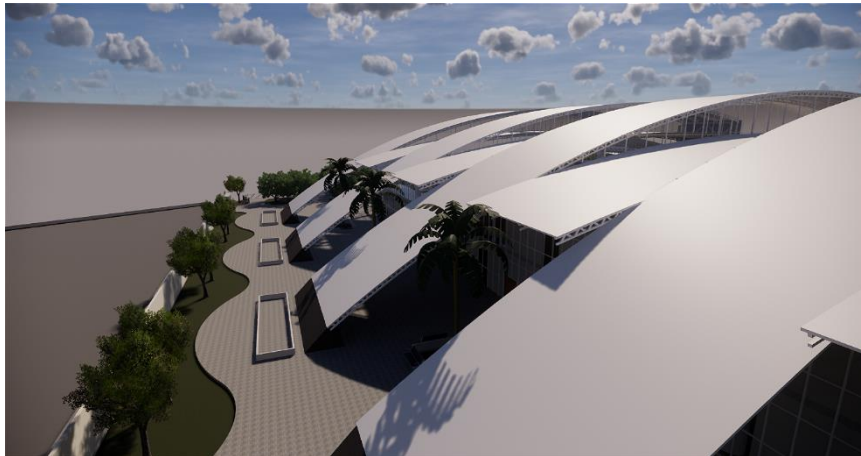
Estructura metálica de apoyo de cobertura. Lado derecho. Fuente propia.
